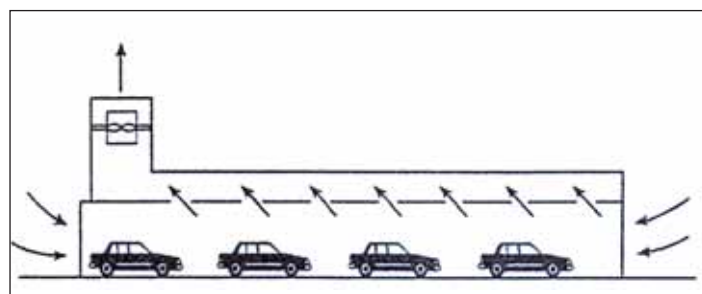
Схема вентиляционного воздухообмена при продольно-поперечной вытяжной схеме вентиляции
